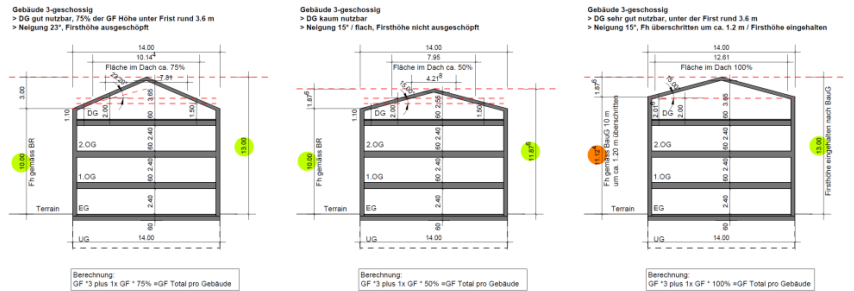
Schnitte zur Untersuchung der Gebäude- und Fassadenhöhe
